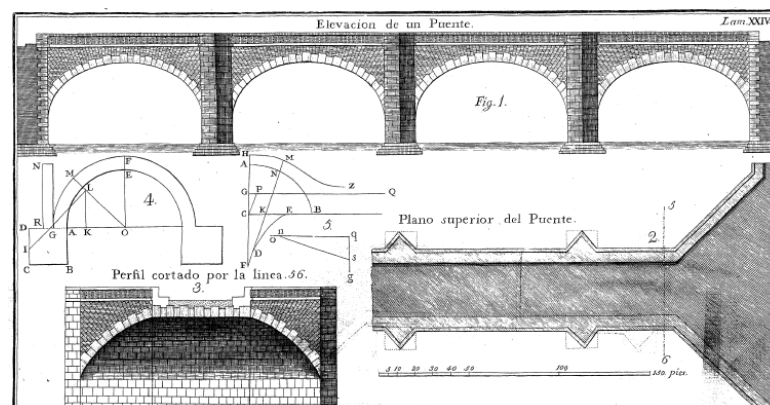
Plano, perfil y elevación de un puente. Tratado de fortificación. Juan Muller.1769
